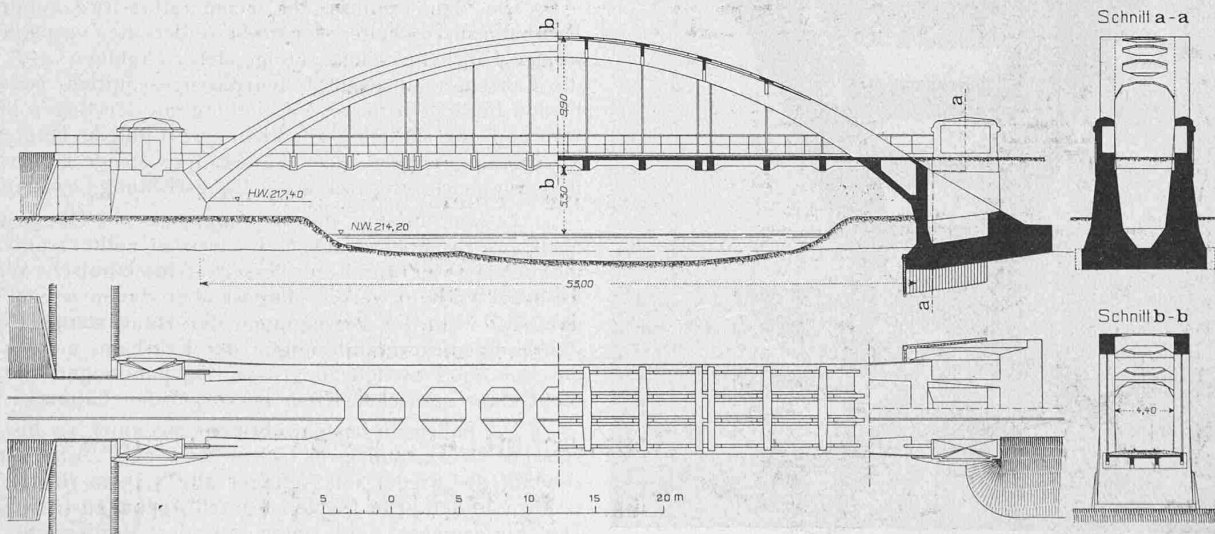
Ansicht, Draufsicht, Untersicht und Schnitte der Werrabrücke bei Heringen. — Masstab 1 : 500.
